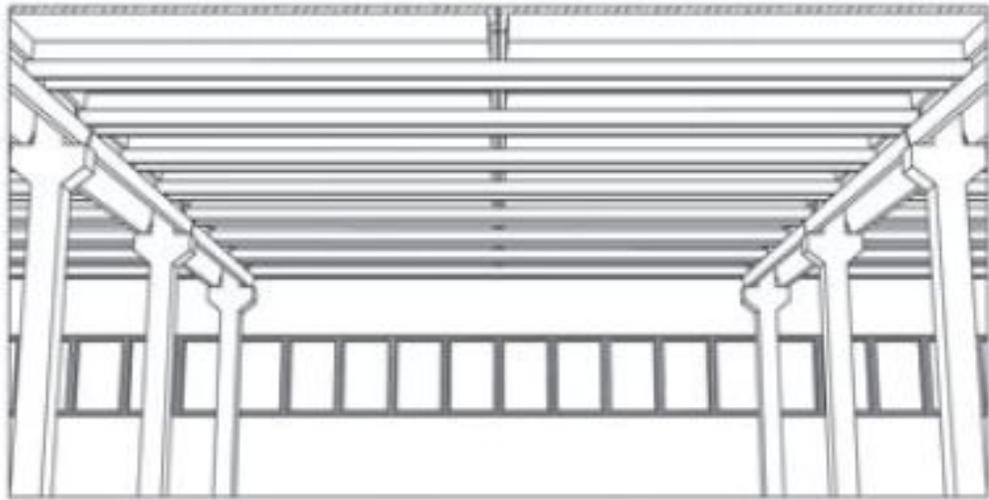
Балочное перекрытие с опиранием ребристых плит на четверти ригелей (серия ИИ-20) при сетке колонн 6x6 м
